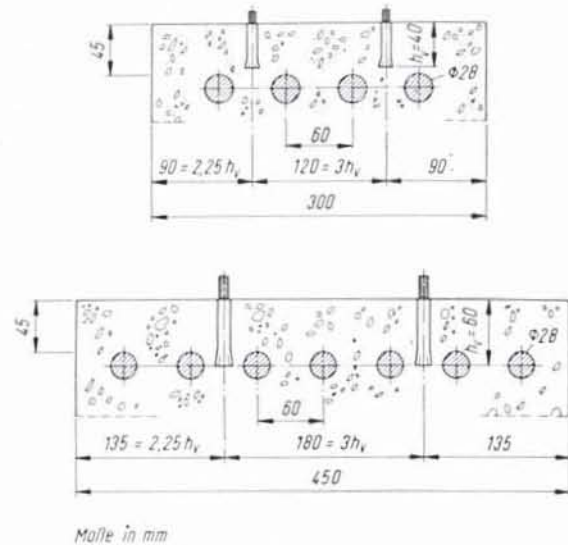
Befestigungen in der Betondeckung hoch bewehrter Balken (Versuche [19])
